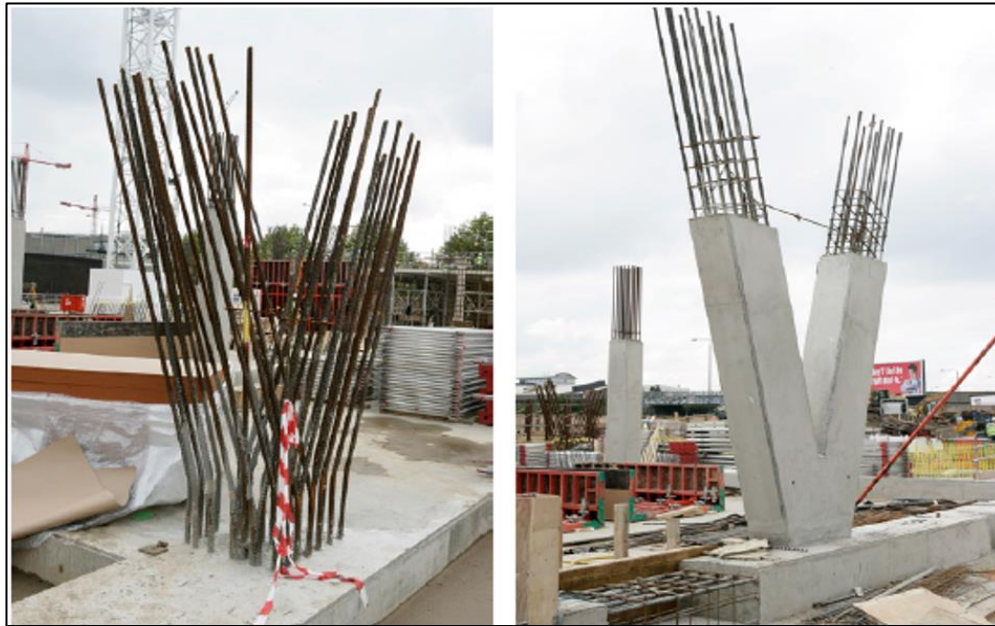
Proceso Constructivos del Edificio Yellow Building. Fuente: link <https://www.ahmm.co.uk/projectDetails/8/The-Yellow-Building>.
